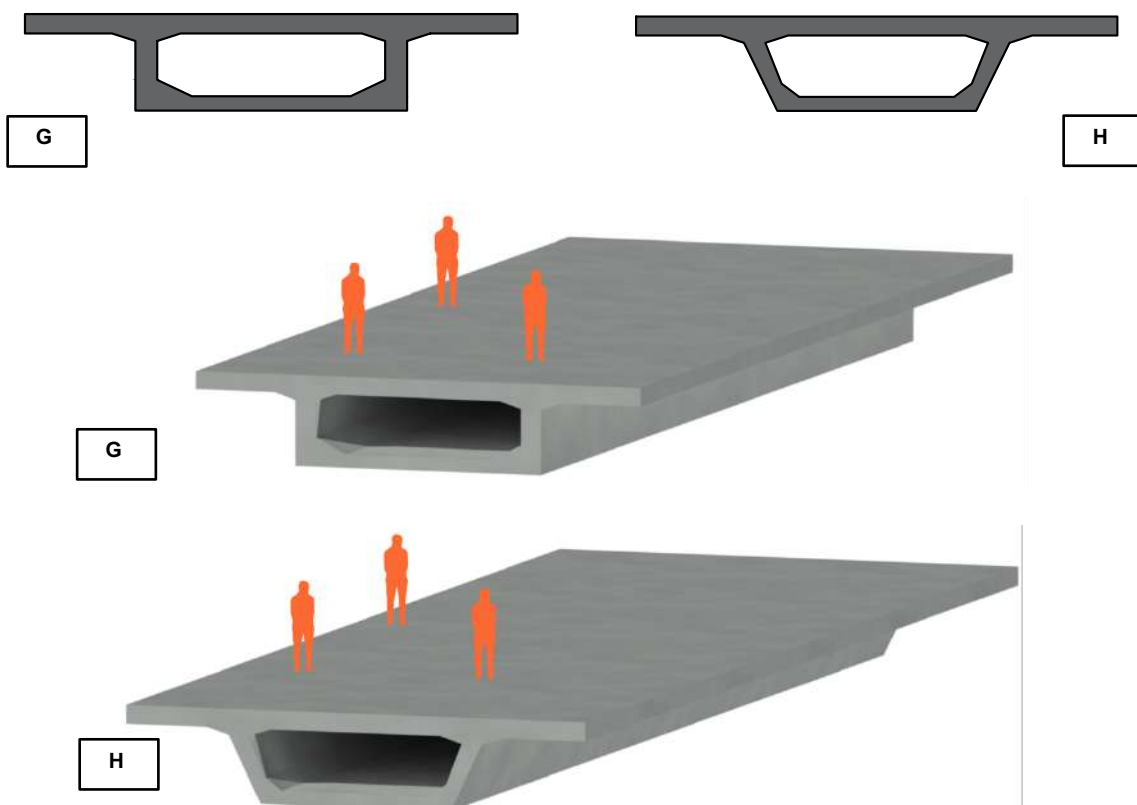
G. Viga “caixão” com paredes verticais. H. Viga “caixão” com paredes verticais inclinadas. Fonte: autoral
